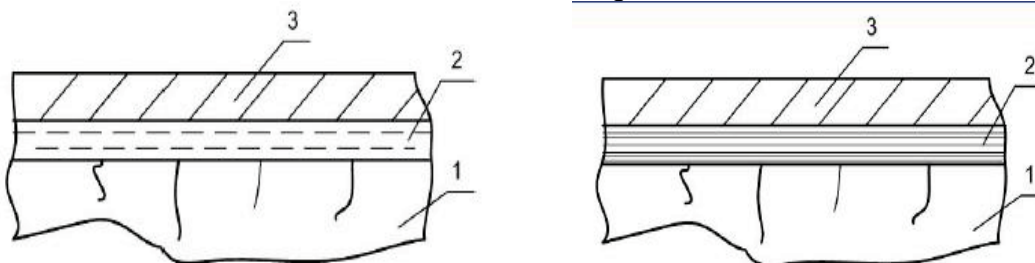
Схема армирования дорожного покрытия геосетками HaTelit,
